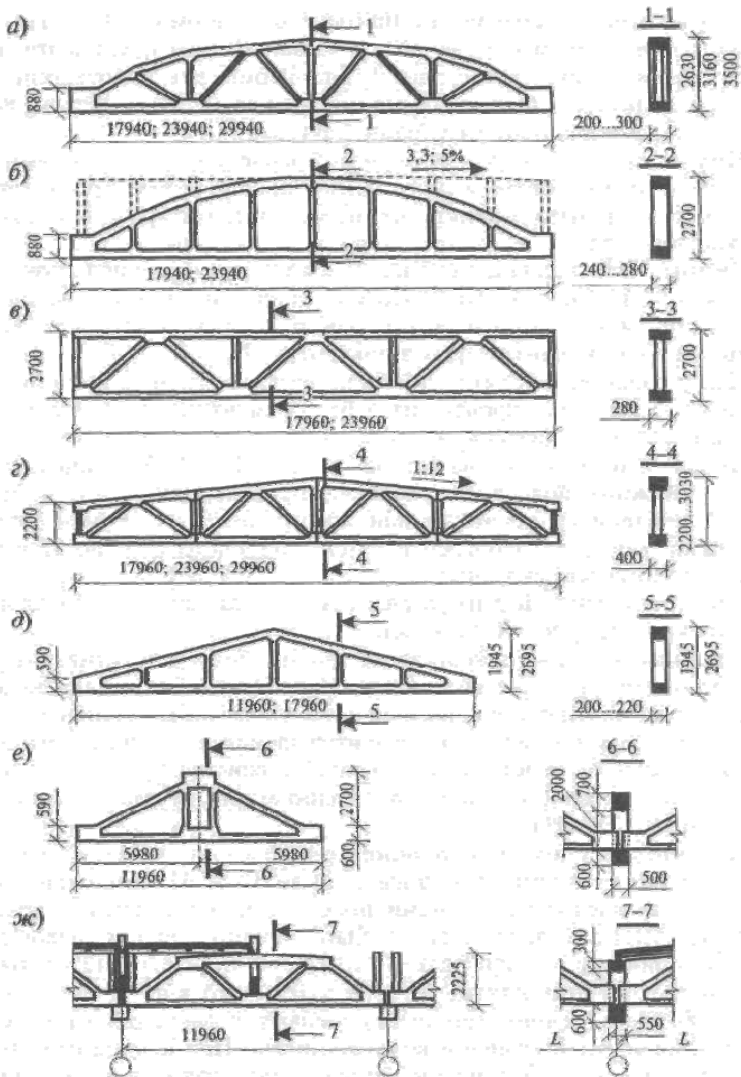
Железобетонные фермы: а – сегментные; б – безраскосные; в – с параллельными поясами; г – полигональные; д – треугольные; е – подстропильные для малоуклонных кровель; ж – подстропильные для скатных кровель (в монтированном положении в покрытии).
